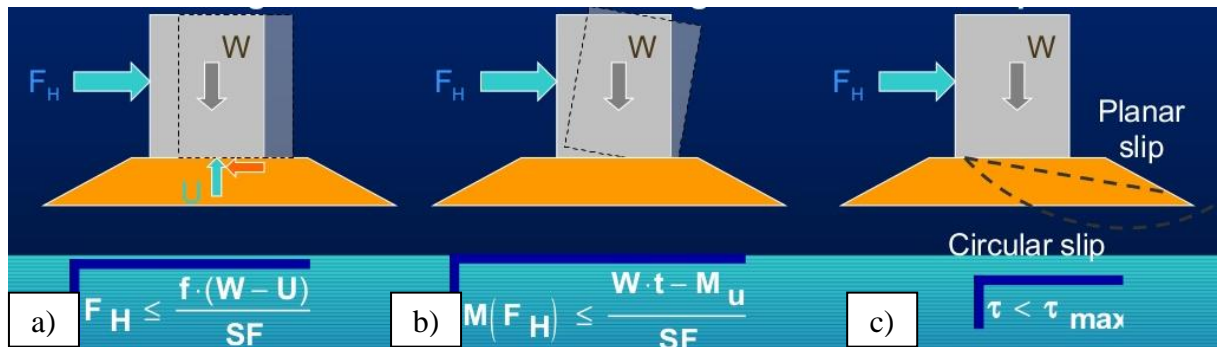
Falha de um quebra-mar vertical por: a) deslizamento, b) derrubamento e c) escorregamento do subsolo
